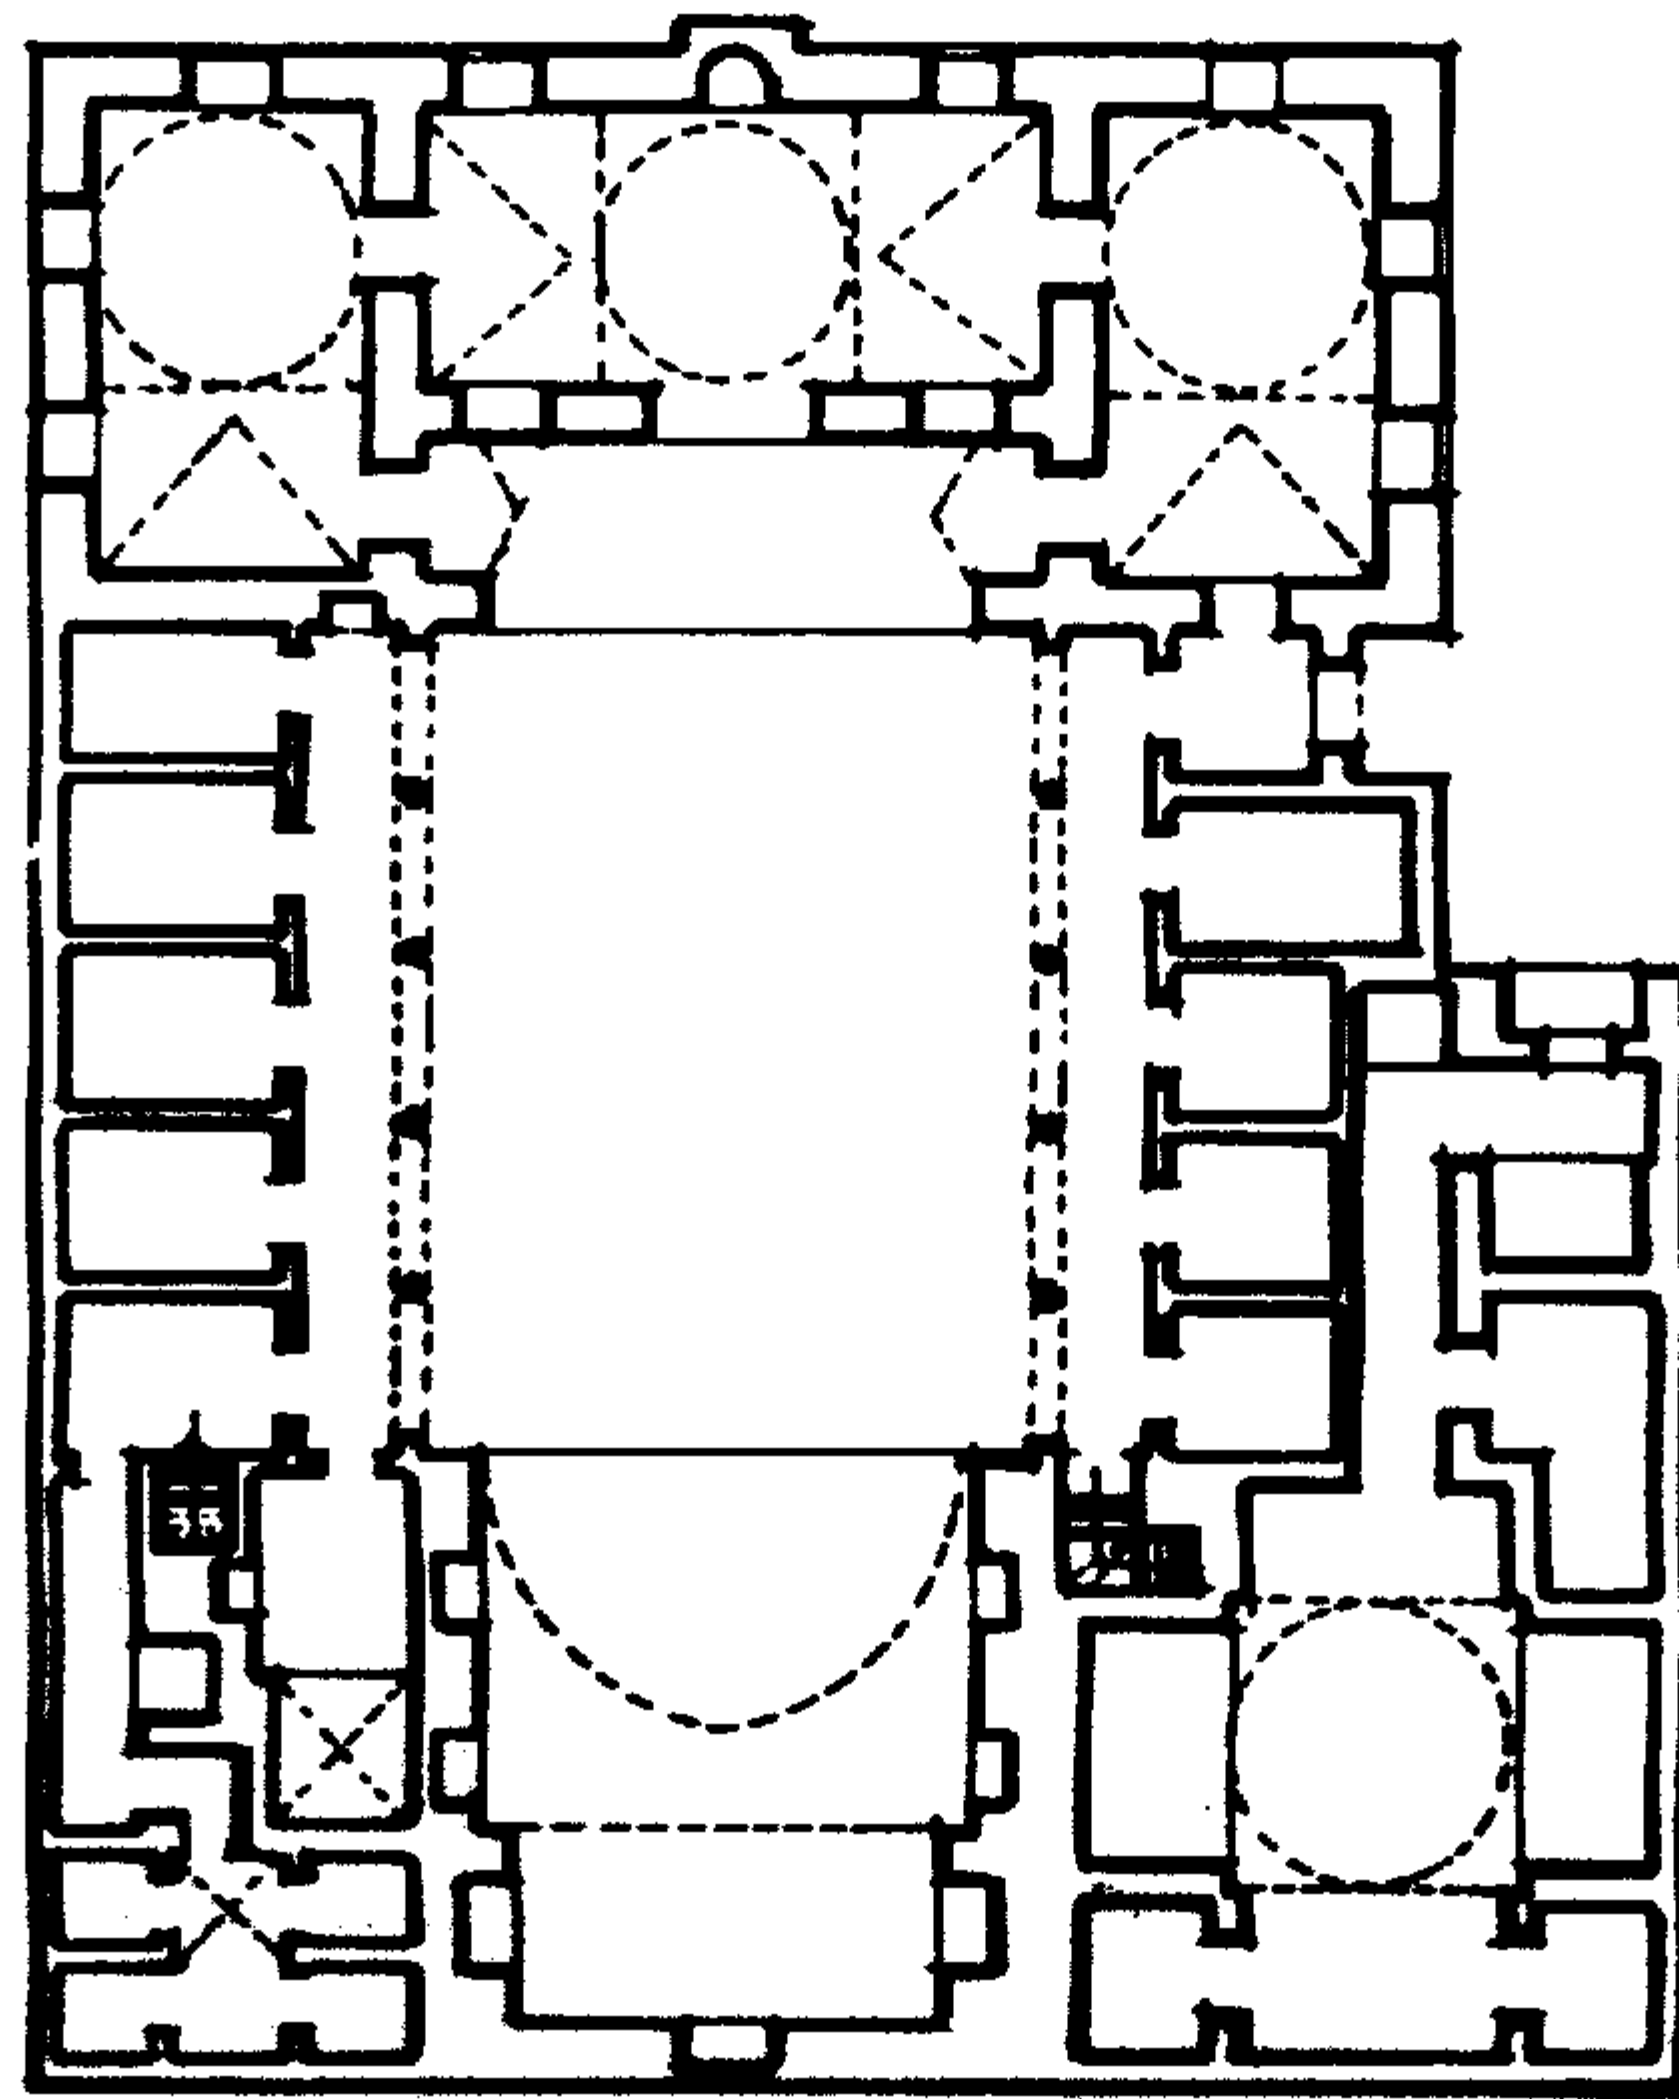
مسقط أفقي لمدرسة المستنصرية ببغداد.
